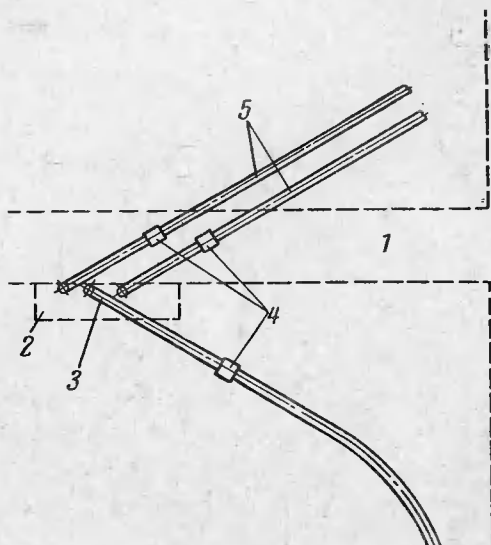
Раскладка магистральных линий над щитовой в подготовке перекрытия.
